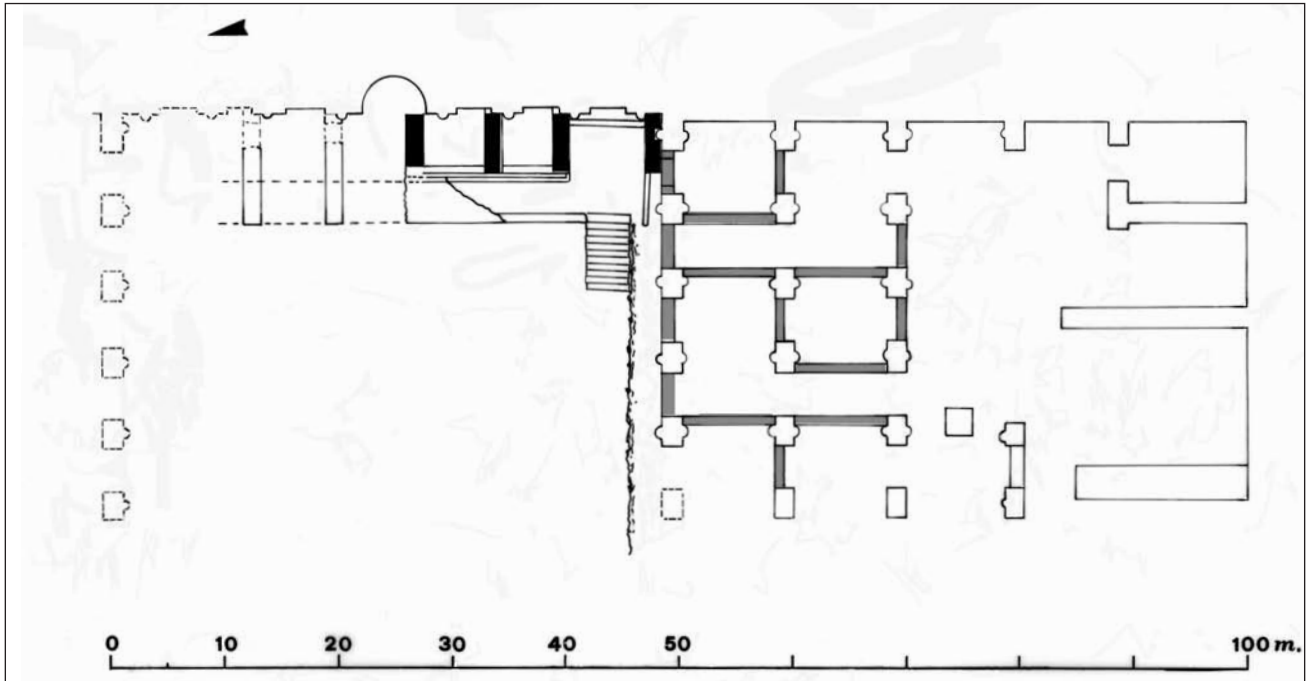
Barco Borghese, planimetria generale degli scavi condotti nel settore esterno: in nero i contrafforti; si notino la scalinata e la rampa di collegamento con il piano superiore delle sostruzioni, realizzate nell'area dell'ipotizzato peristilio (foto: M. Valenti).
